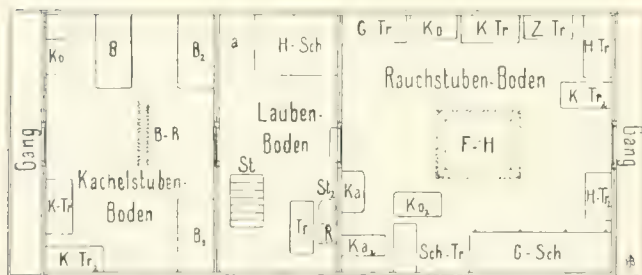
Grundriß des Dachraumes des Kliegl-Hauses.
